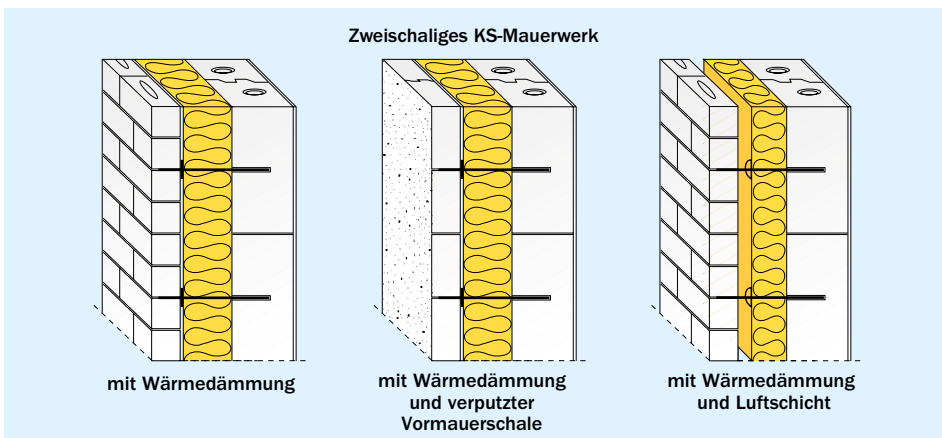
Zweischalige KS-Außenwandkonstruktionen für beheizte Gebäude
